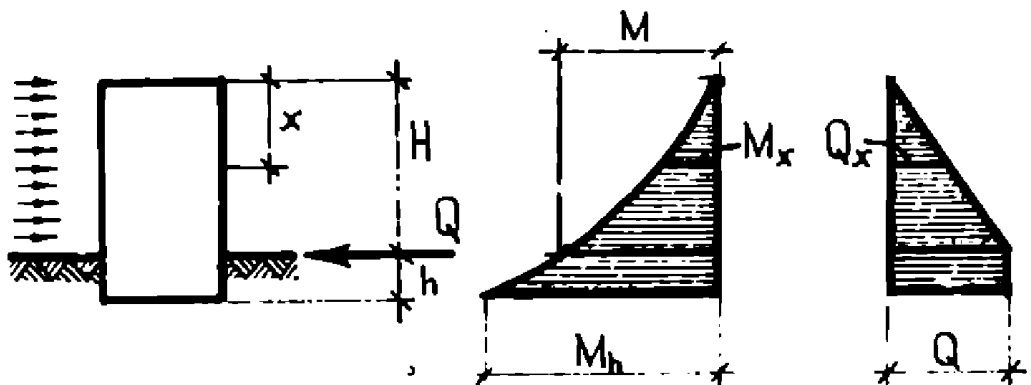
Схема к определению усилий в характерных сечениях здания от ветровой нагрузки согласно [6]
